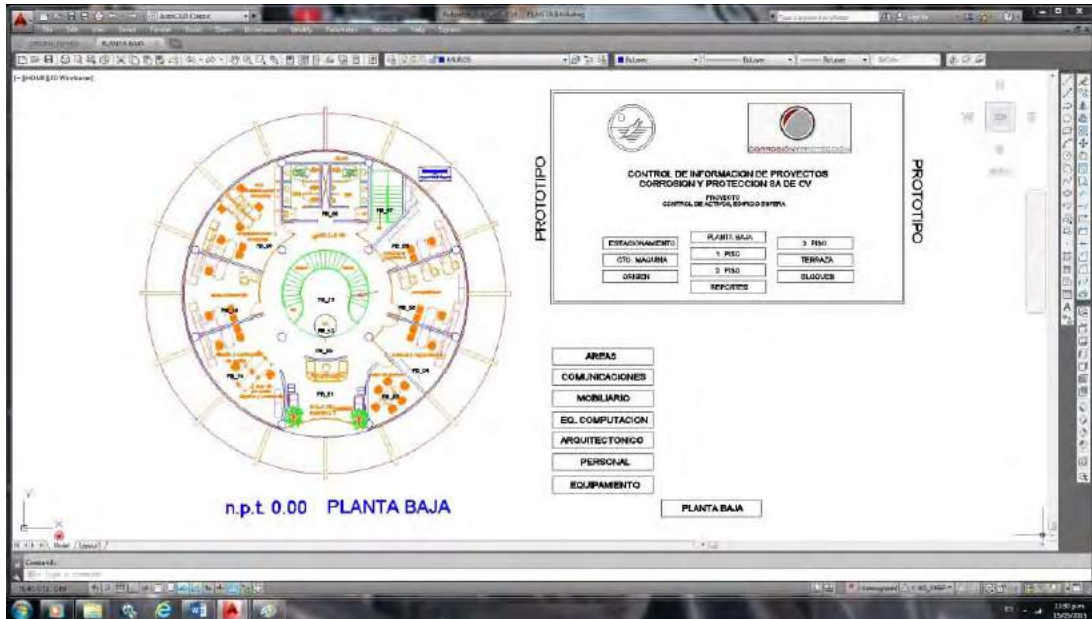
Pantalla principal “Planta Baja”, ubicación botón “Reportes”, fuente Baruch Martínez.
